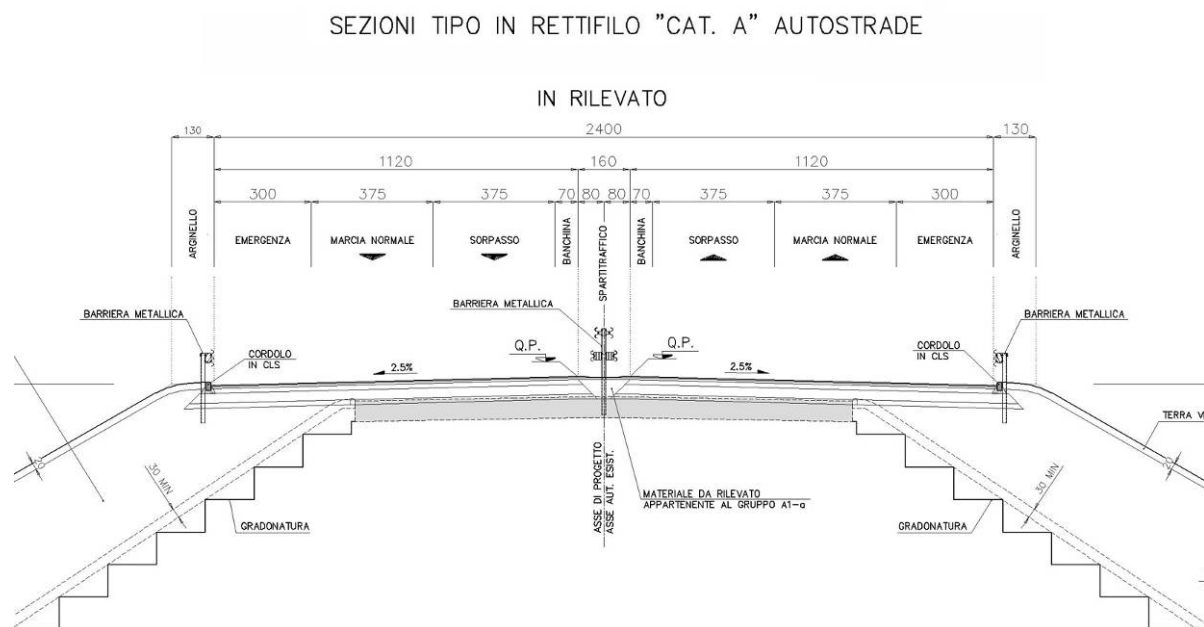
Sezione tipo di progetto (adeguamento simmetrico Variante SS1 Aurelia)
